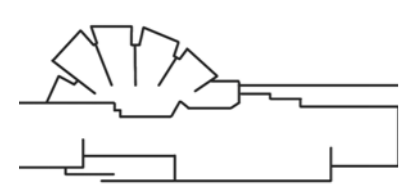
Planta esquemática da biblioteca Rovaniemi City.
